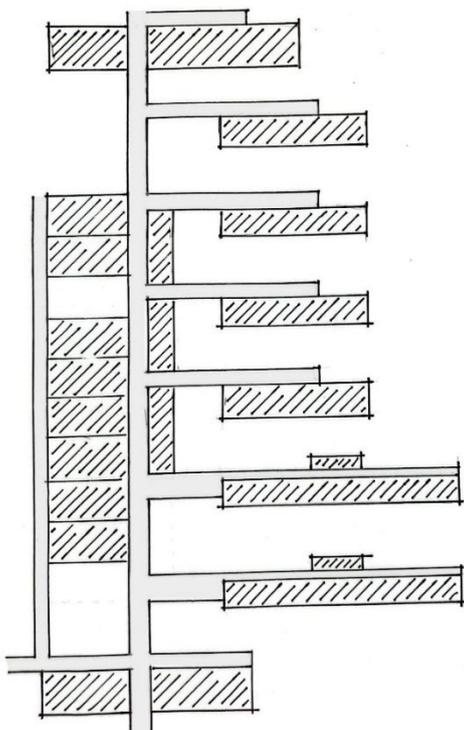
Croquis de implantação da Creche Universitária, com planta de base centrífuga.
